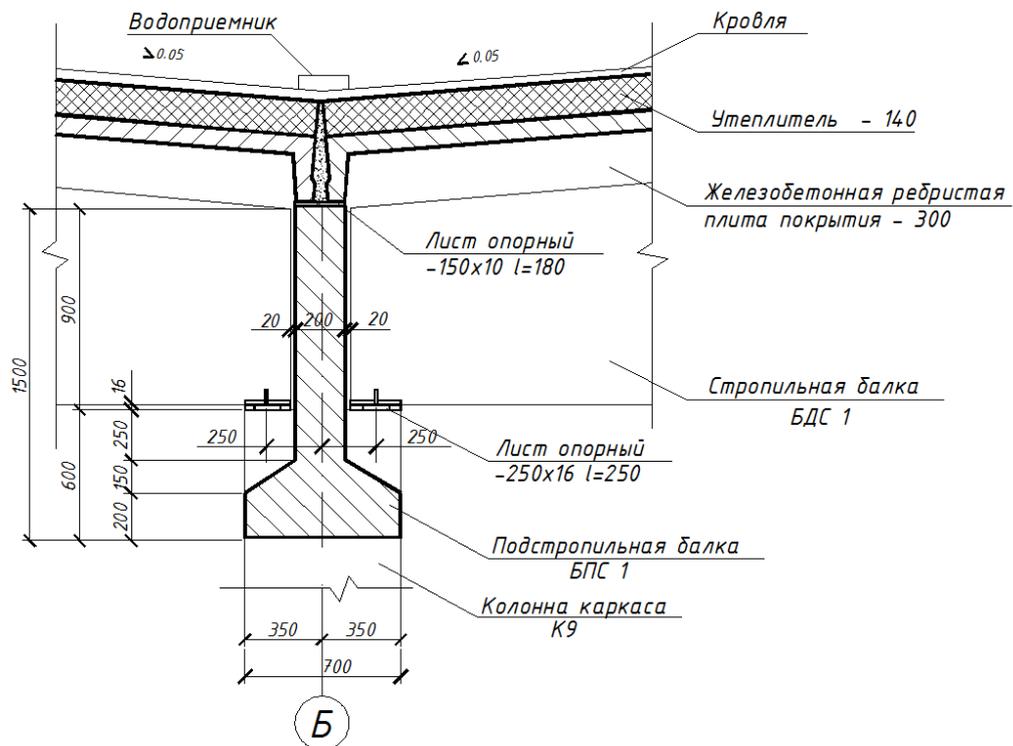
Узел сопряжения стропильных и подстропильных конструкций промышленного здания
